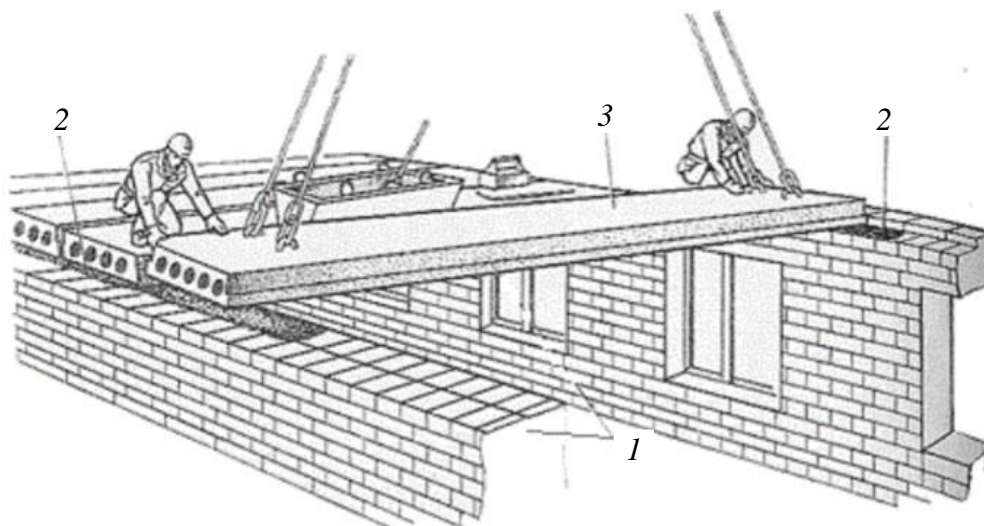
Монтаж сборного перекрытия: 1 – несущие стены; 2 – монтажный раствор; 3 – плита перекрытия
